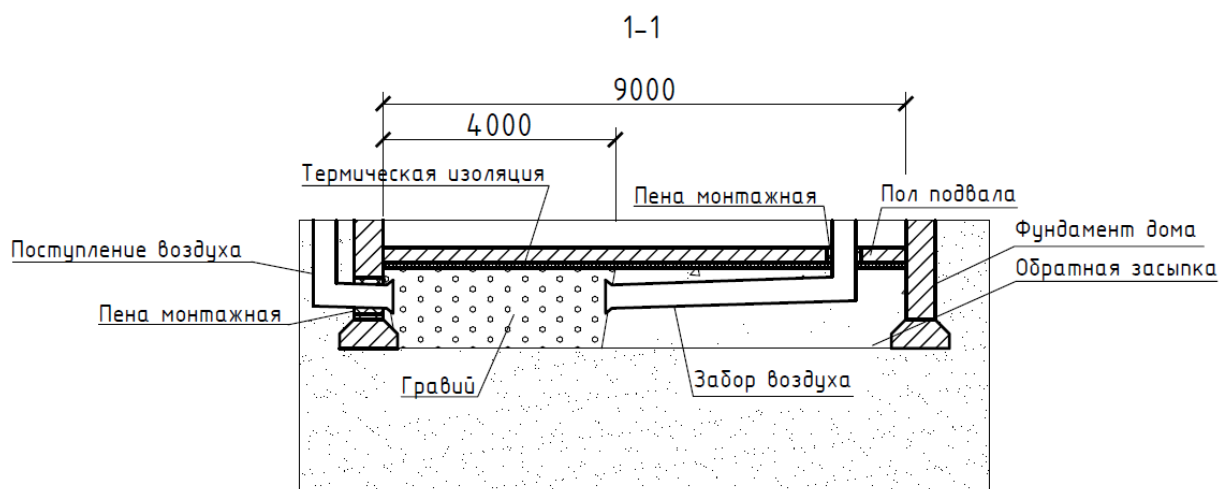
Вариант устройства бесканального теплообменника совместно с фундаментом здания. Разрез 1-1
